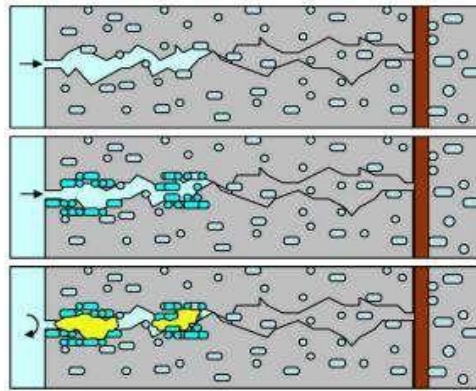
Reparación de grietas y bacterias en el concreto
